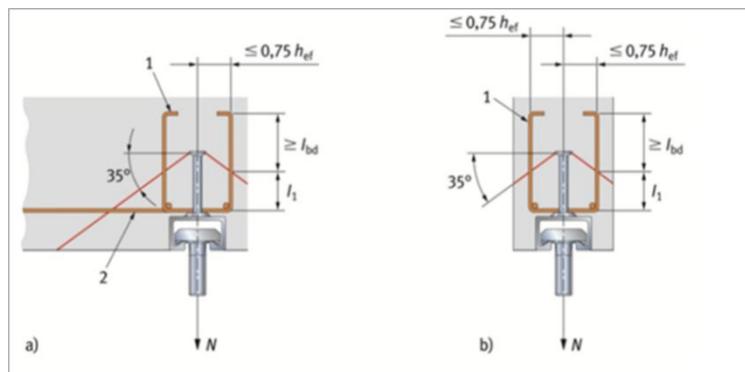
槽式预埋件受拉时附加钢筋布置示意图
